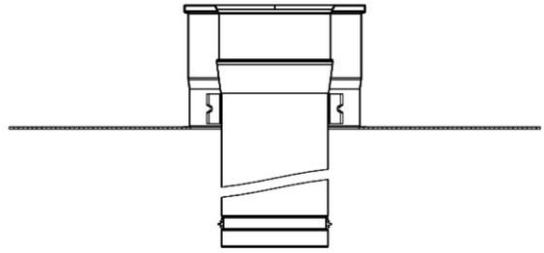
Réutilisation d'un conduit existant avec conduit simple paroi Ros SP
